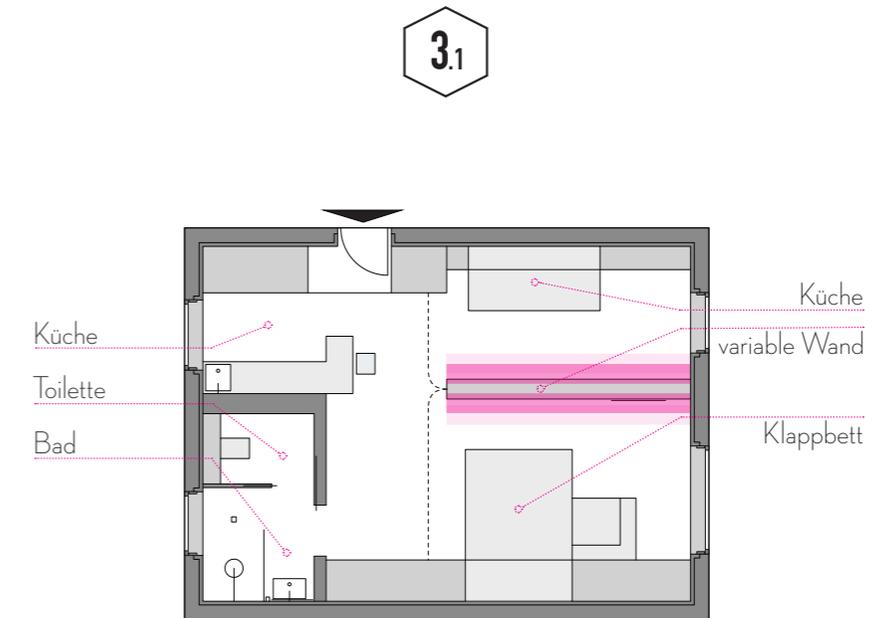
Grundriss:: Variante für zwei/drei
